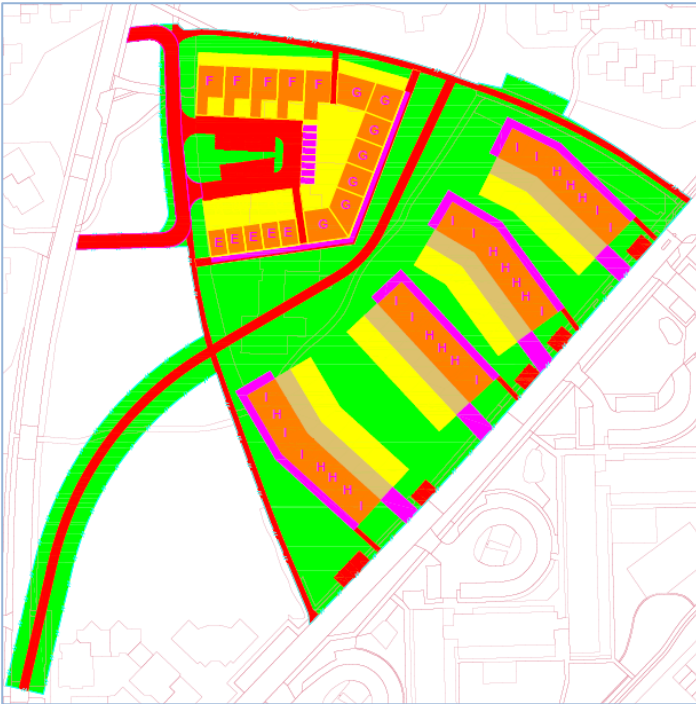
Plangebied en ruimtegebruik bestaand (schets gemeente)
